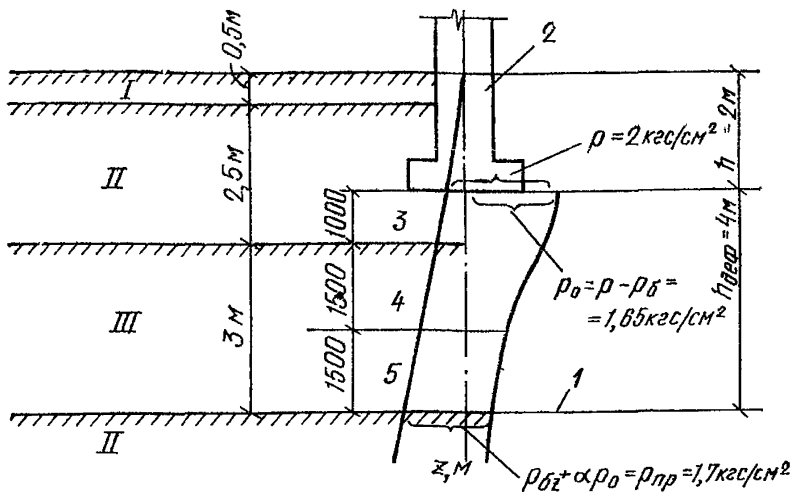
Расчетная схема распределения давлений в основании фундамента для примера расчета просадок
